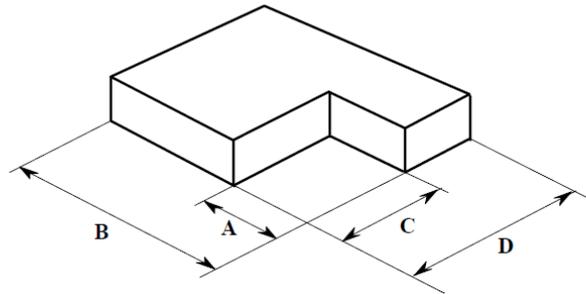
Figura A.3-1 Irregularidades en planta Tipo 2P del Reglamento NSR-10
